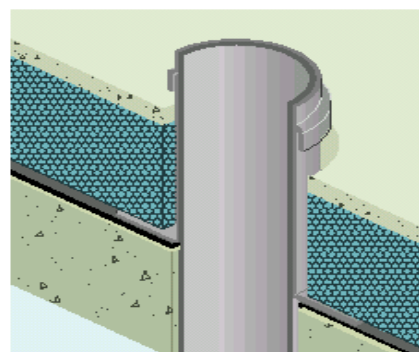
Encuentro de baldosa de XPS con bajante.
